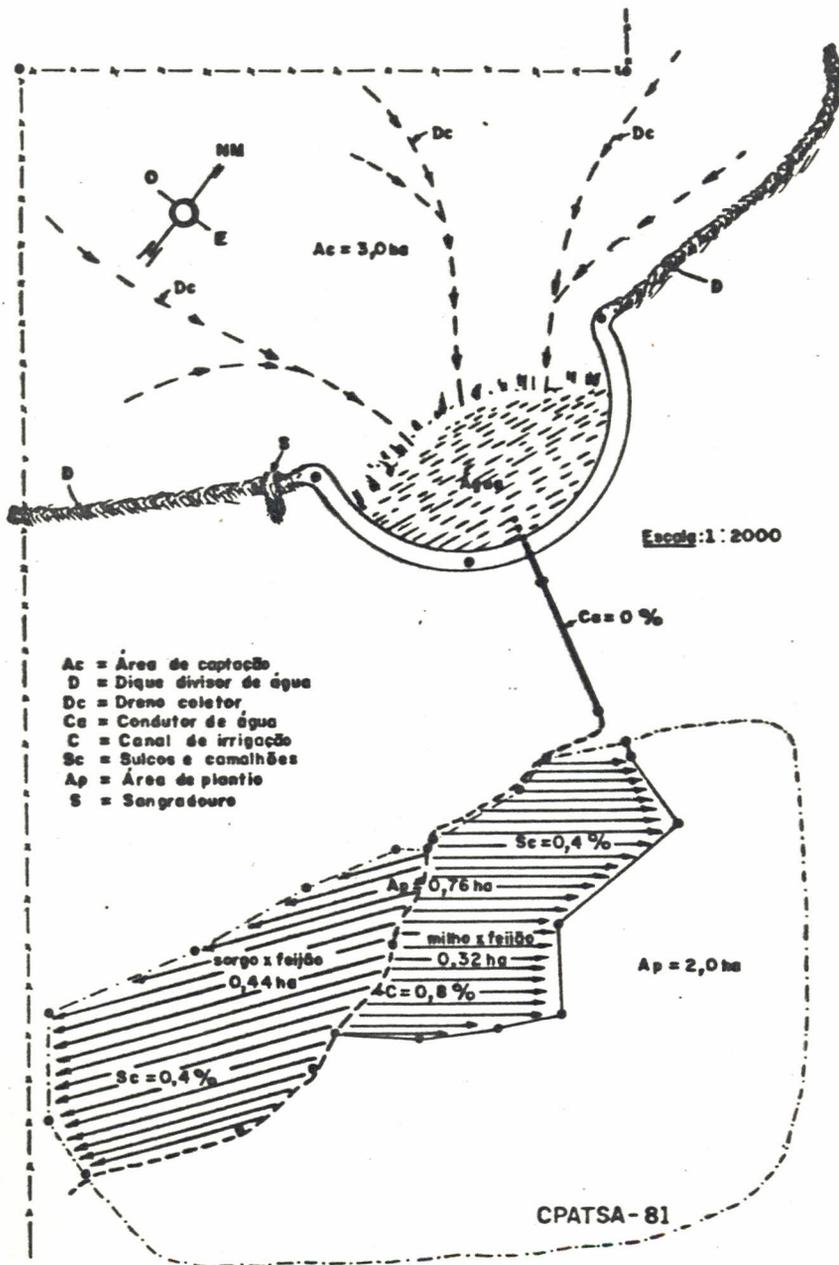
Sistema de produção em áreas de sequeira: barreiro para uso em irrigação de salvação.
